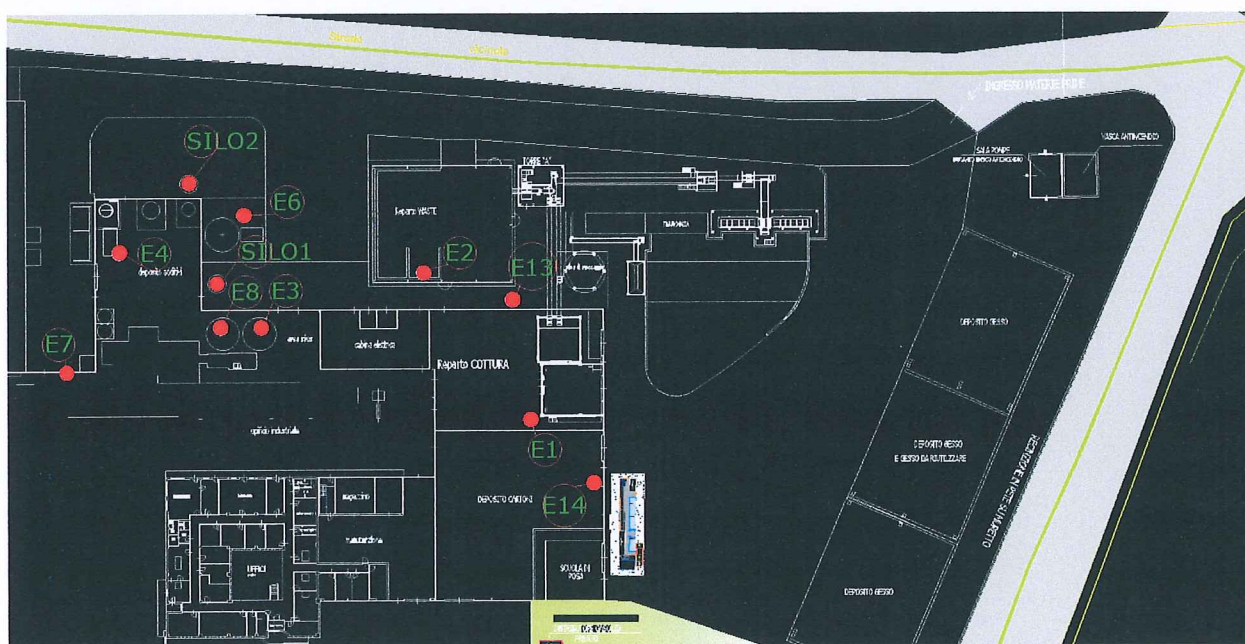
ESTRATTO PLANIMETRIA DI STABILIMENTO CON INDICAZIONE NUOVO PUNTO DI EMISSIONE (E14).
